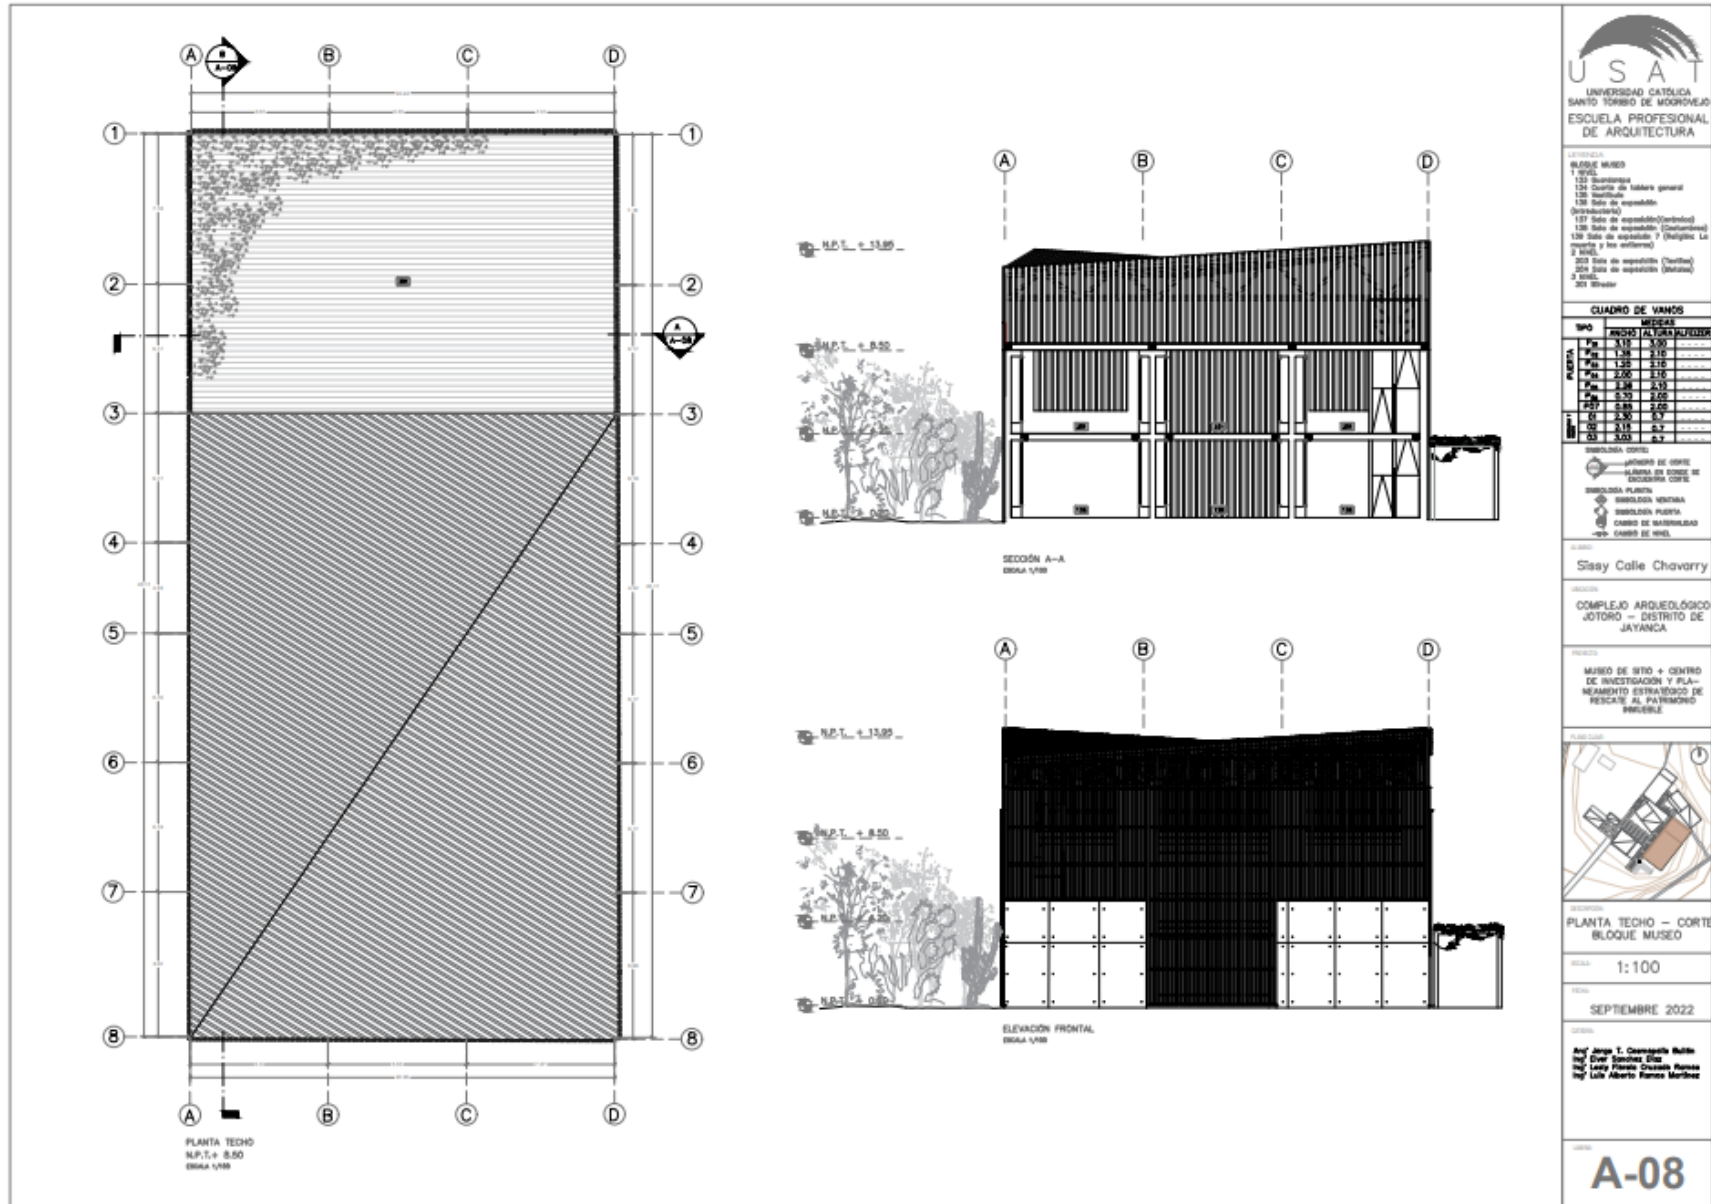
Planos de detalle bloque museo. Fuente: Propia
